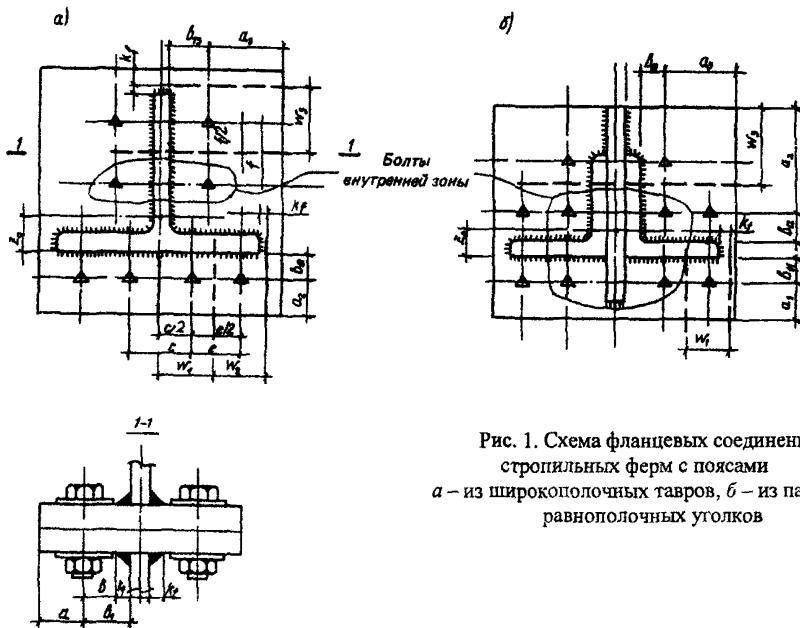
Схема фланцевых соединений стропильных ферм с поясами
